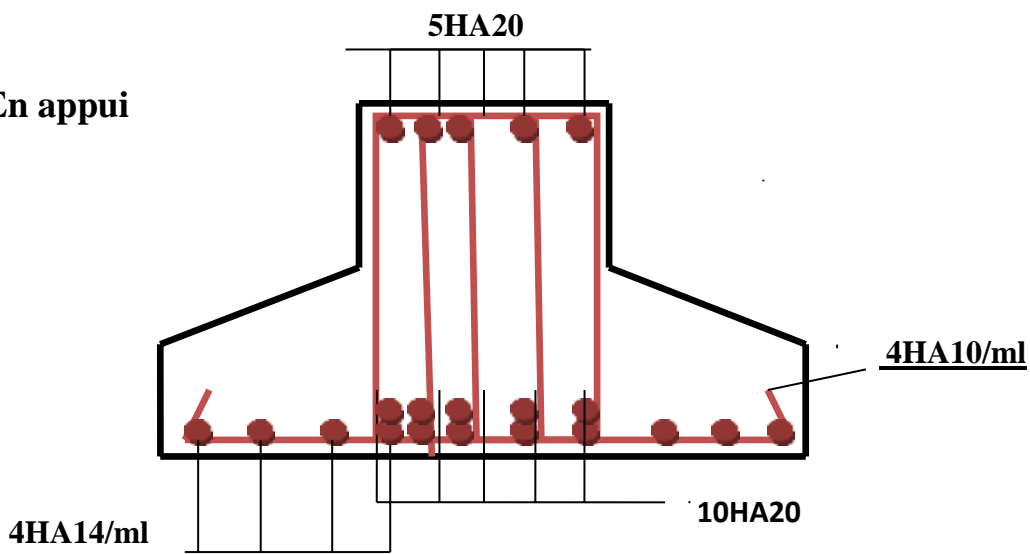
Schéma de ferrailage de la semelle filante (coupe A-A)
